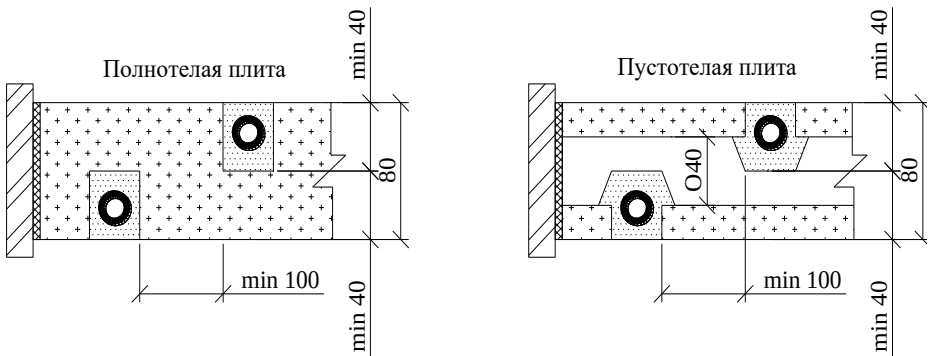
Монтаж трубопроводов диаметром до 20 мм в одинарной перегородке
